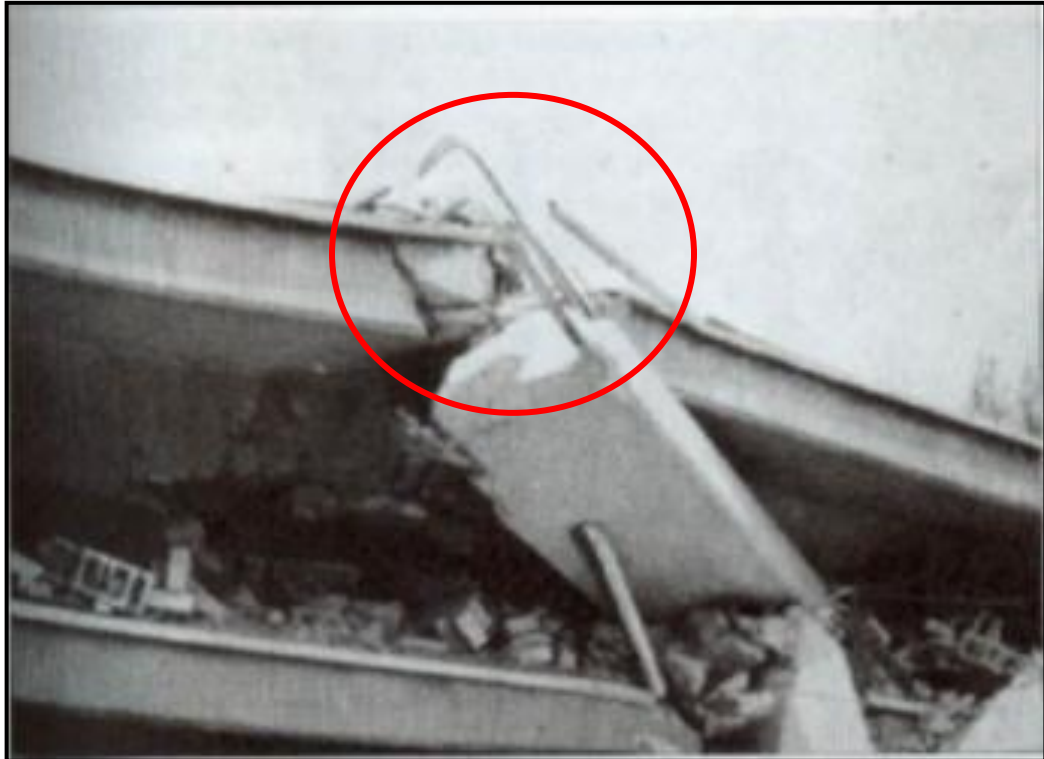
Falla en unión viga-columna por escasez de anclaje en la conexión de la columna con el sistema de piso
